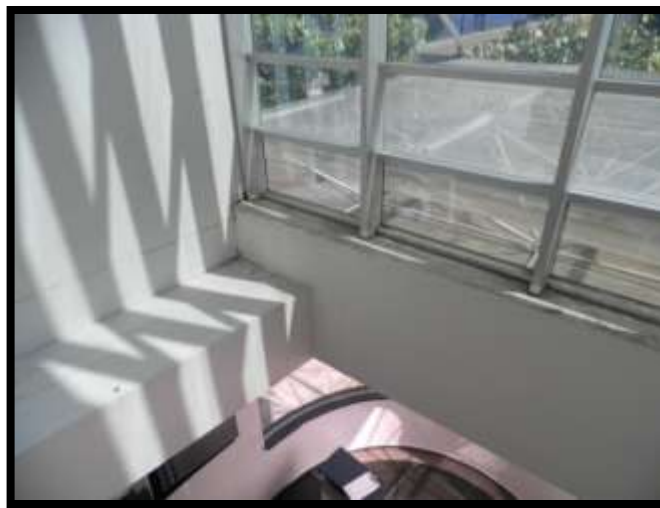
Figa Falsa En Superboard De Fachada Parte Baja Manchada Por La Humedad.
